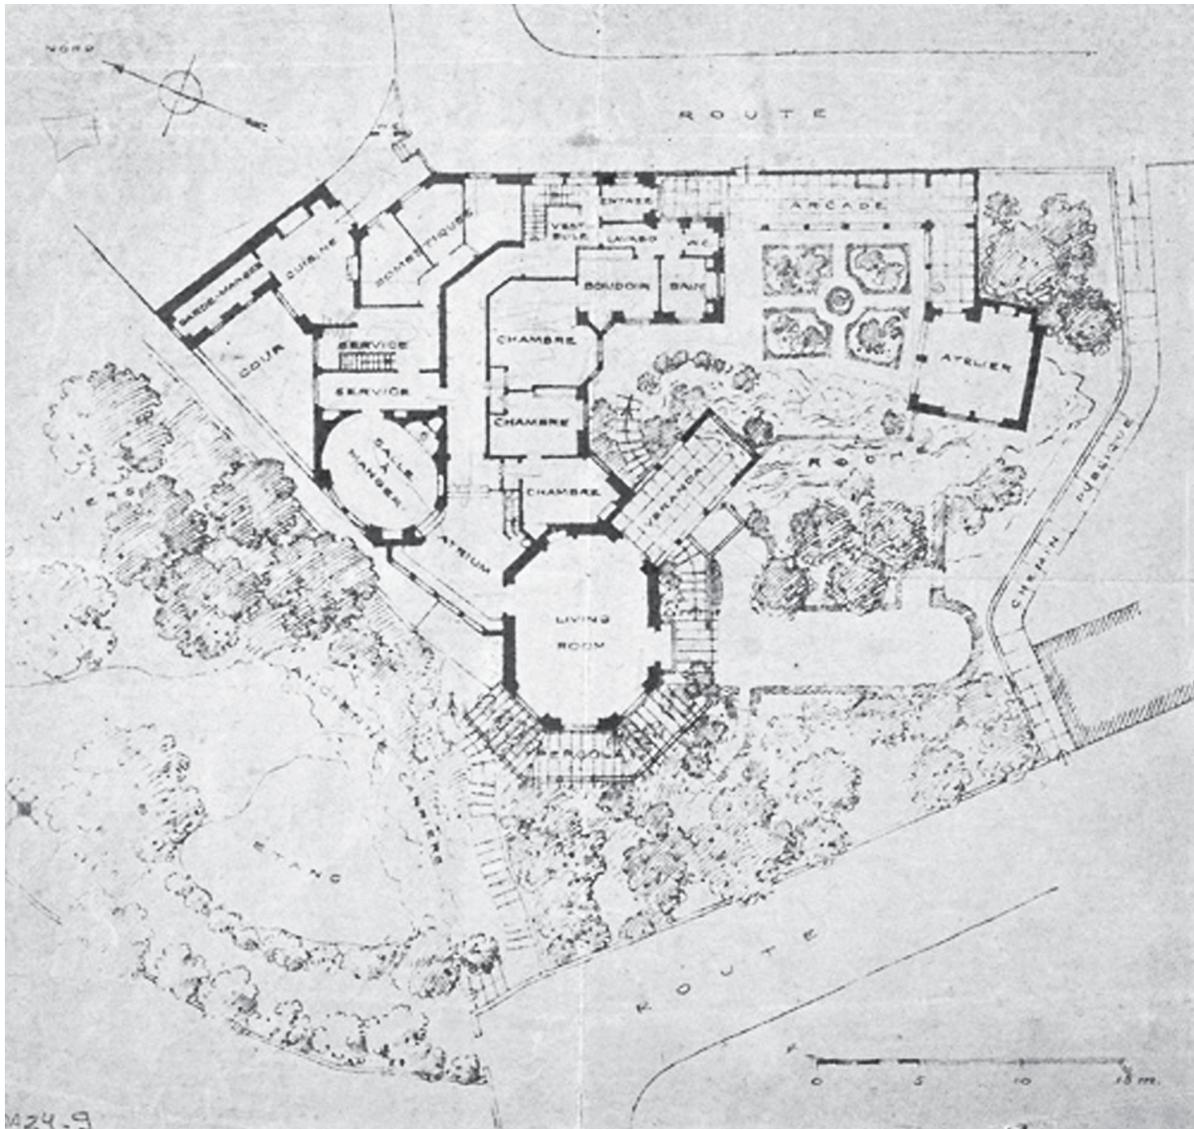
Casa do Cipreste, Sintra, Portugal. Planta.
